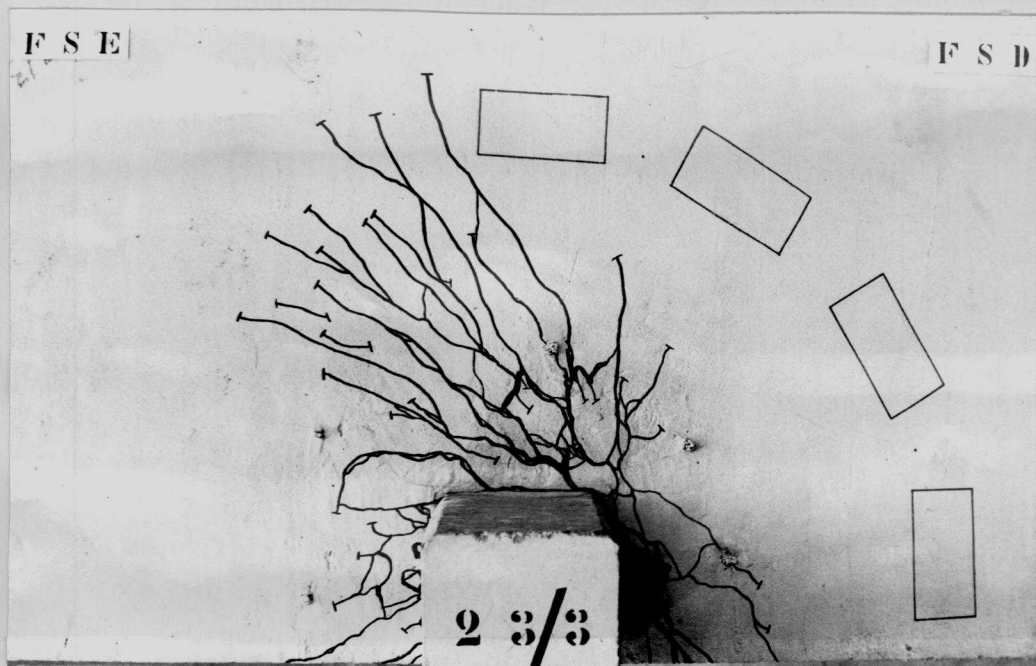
a - Fissuração na face superior do modelo EdL 23/3.
